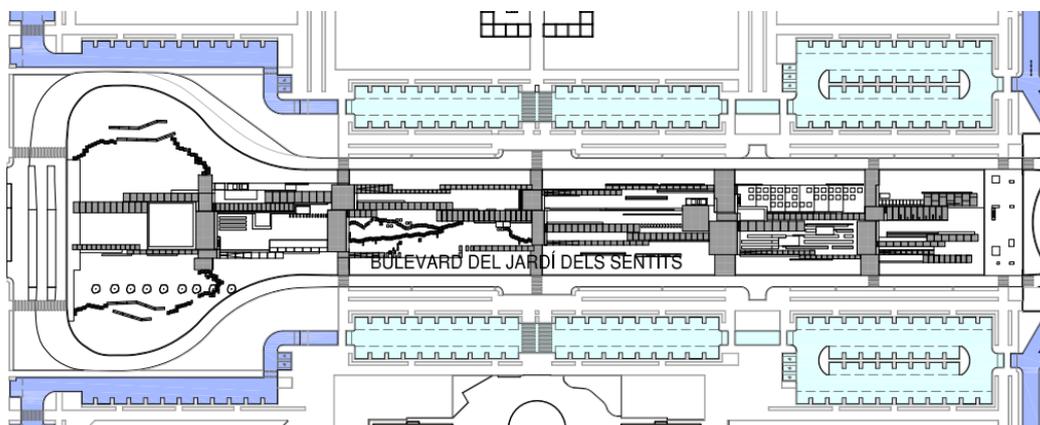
Vista en planta de la zona ajardinada central del campus de la Universitat Jaume I (Plano facilitado por la Oficina Técnica de Obras y Proyectos de la UJI)
